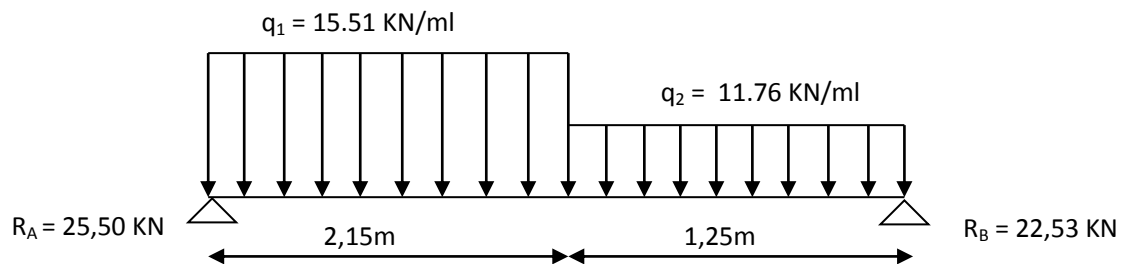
SCHEMA STATIQUE DE CALCUL D'ESCALIER A L'ELU.
